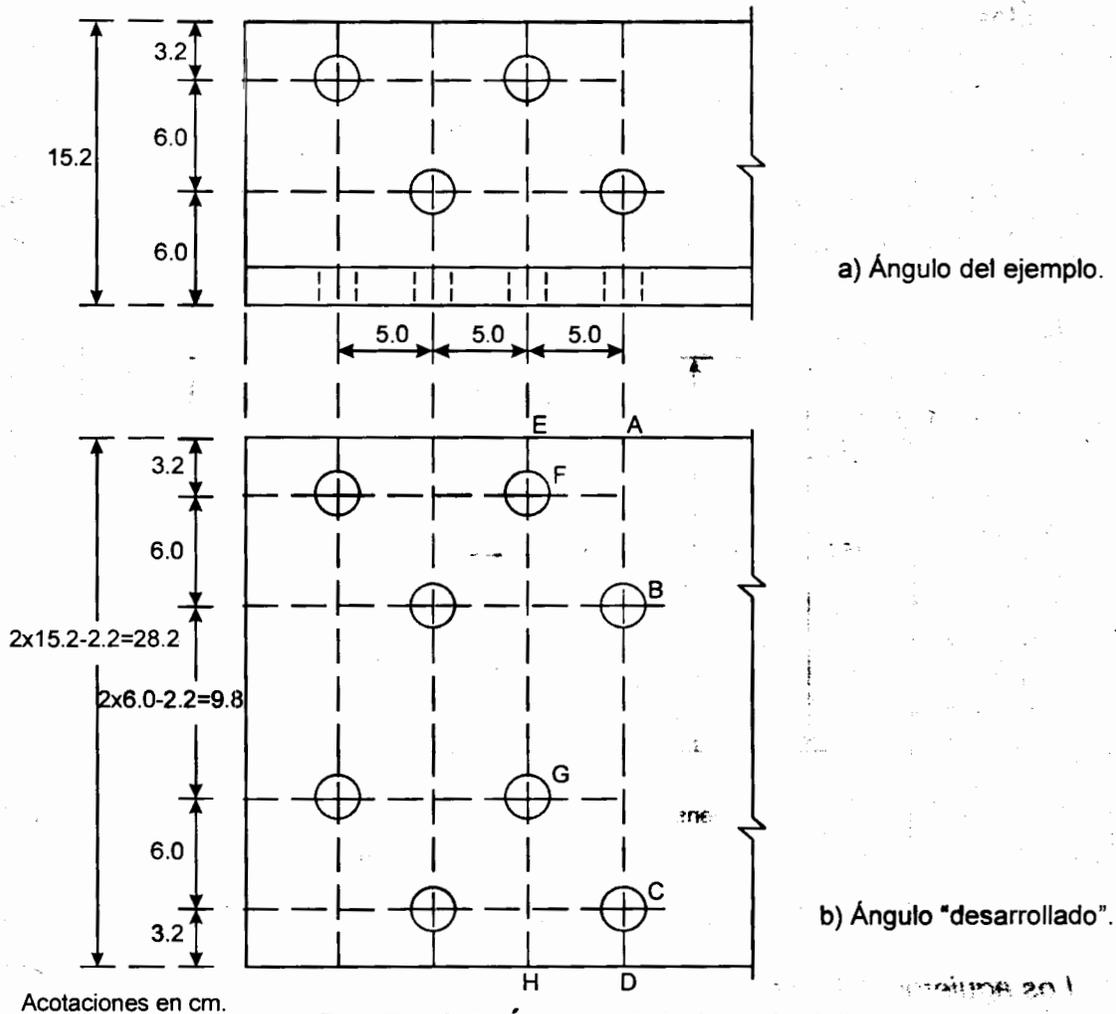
Ángulo del ejemplo 1.3.
